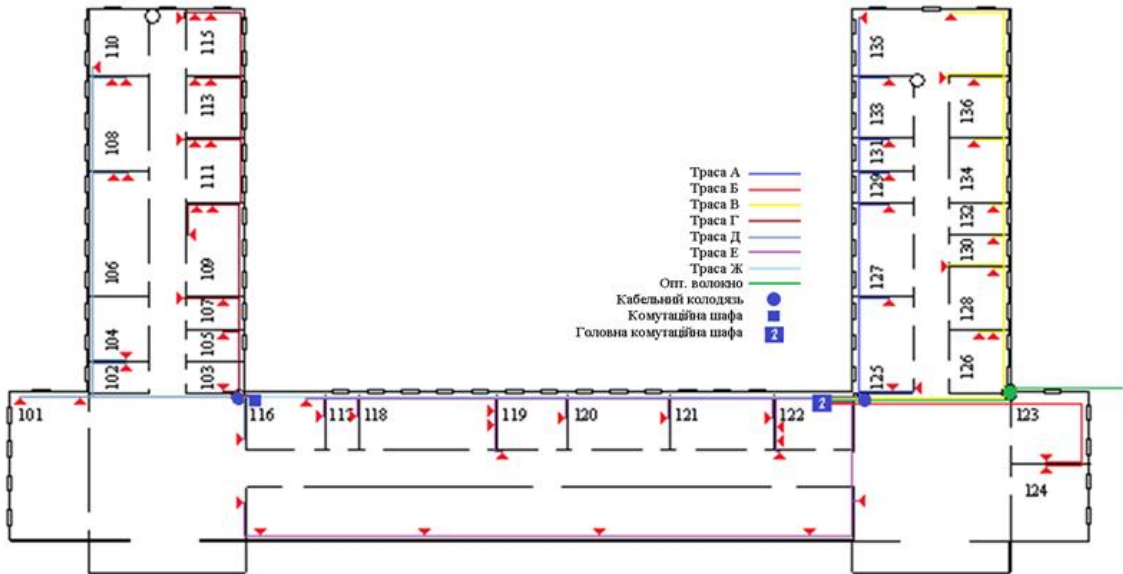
План проведення кабельних трас на першому поверсі будівлі №1
